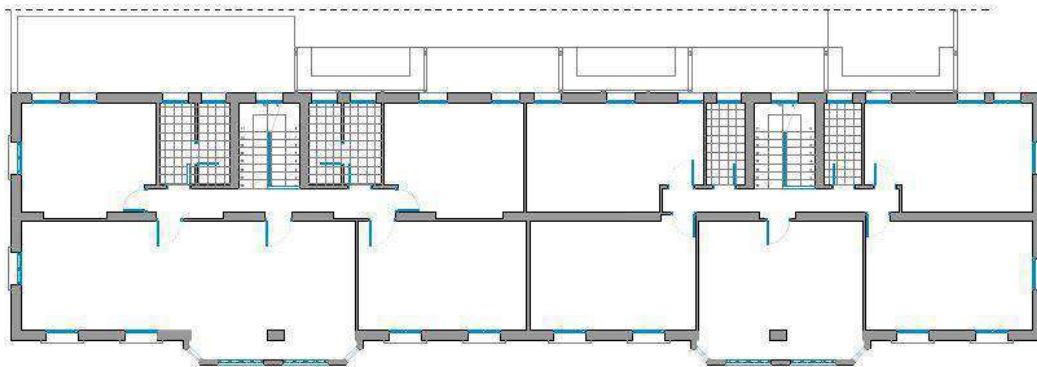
Distribución planta segunda. 2016. Fuente Propia
